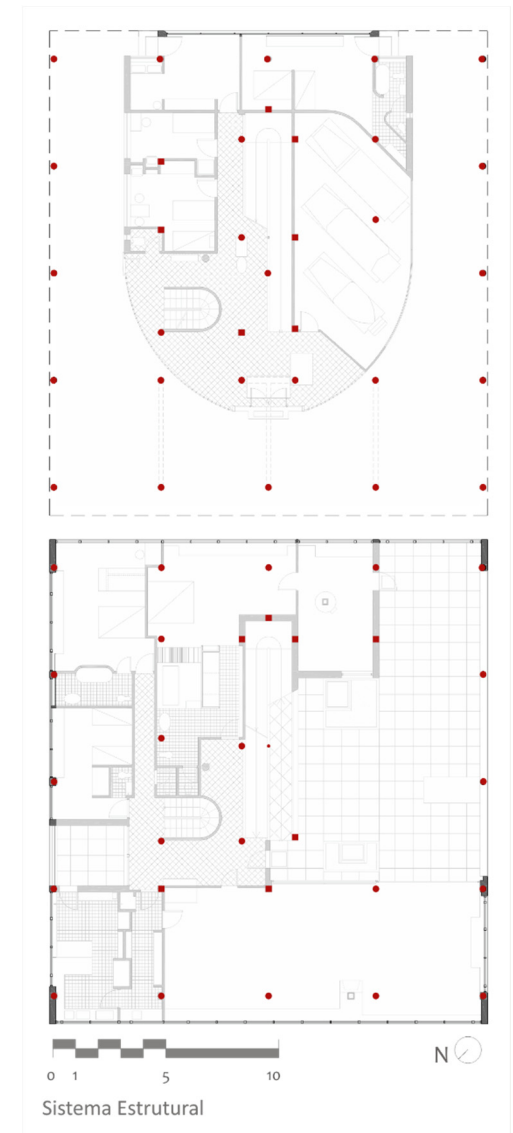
Vila Savoye. Diagrama do sistema estrutural versus fachada. Térreo e primeiro pavimento respectivamente. Fonte: Autora, 2016
